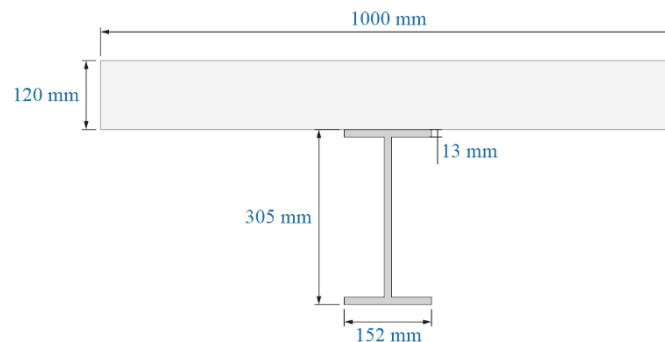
Seção transversal de um sistema de piso composto por laje de concreto e viga pPRFV
